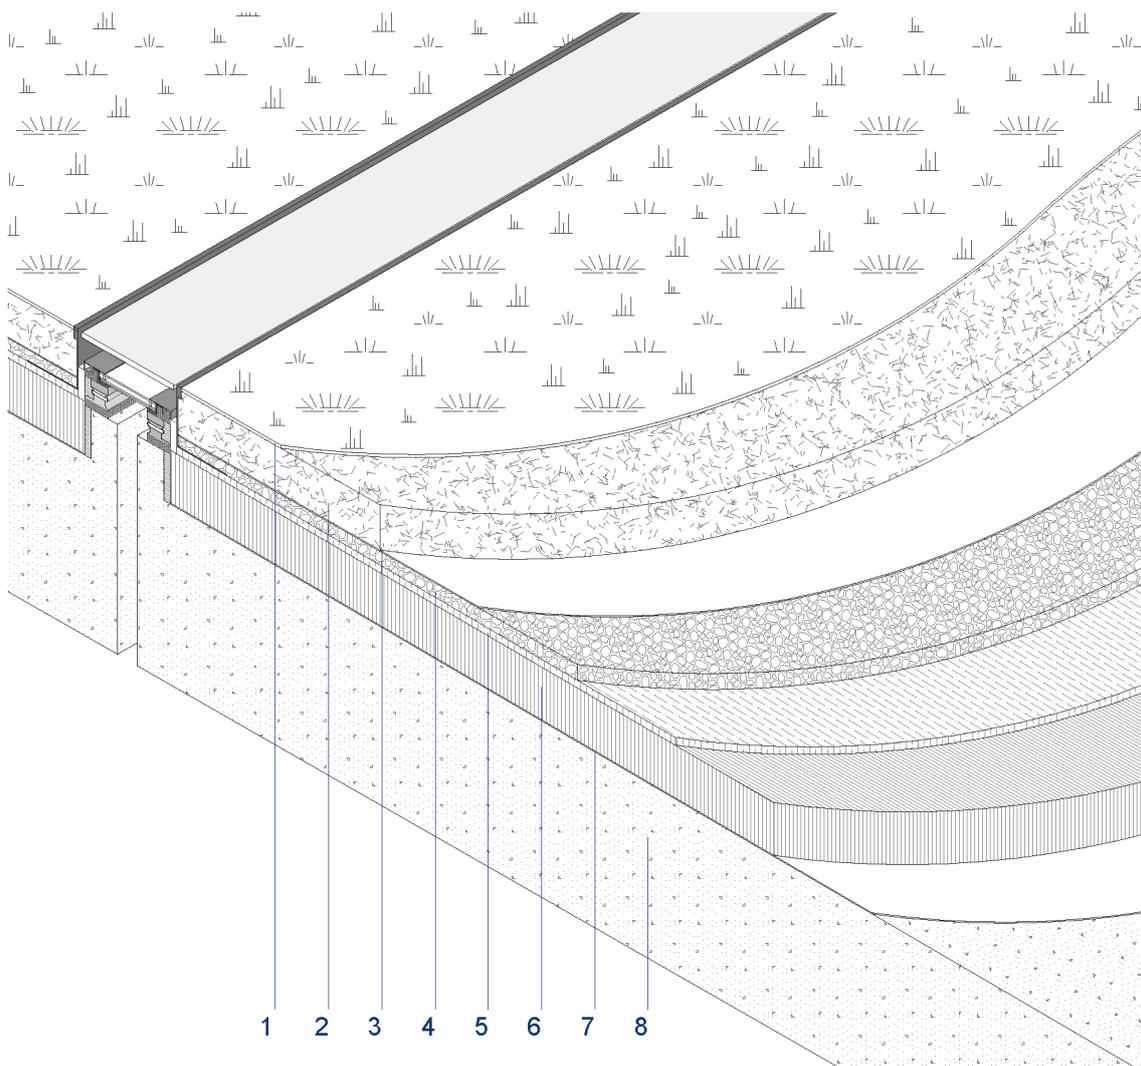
Axonometría E: 1/50. Detalle de las capas de la cubierta.
